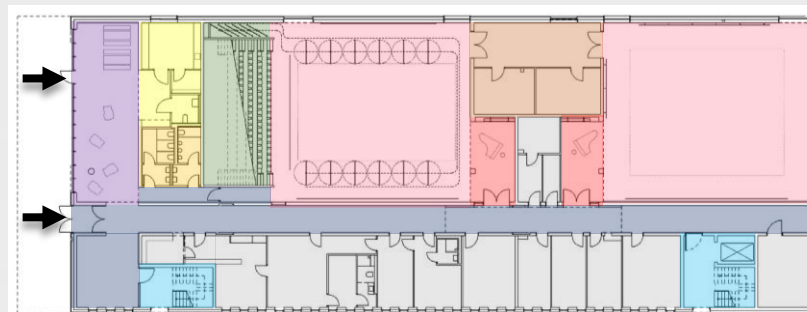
Planta Baixa do térreo (GMP ARCHITEKTEN, 2019).
